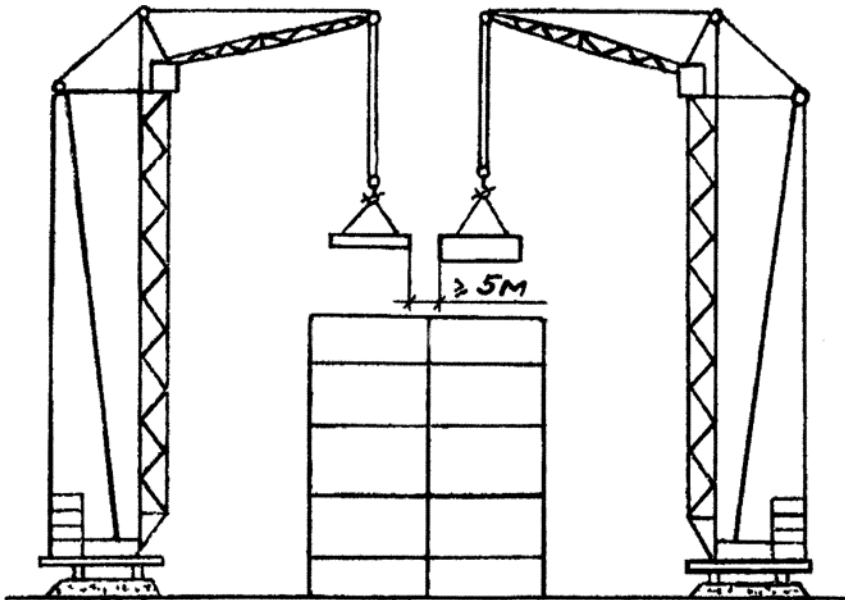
Схема одночасного монтажу конструкцій будівлі двома баштовими кранами (розріз 1-1 до рис. 14.11)
